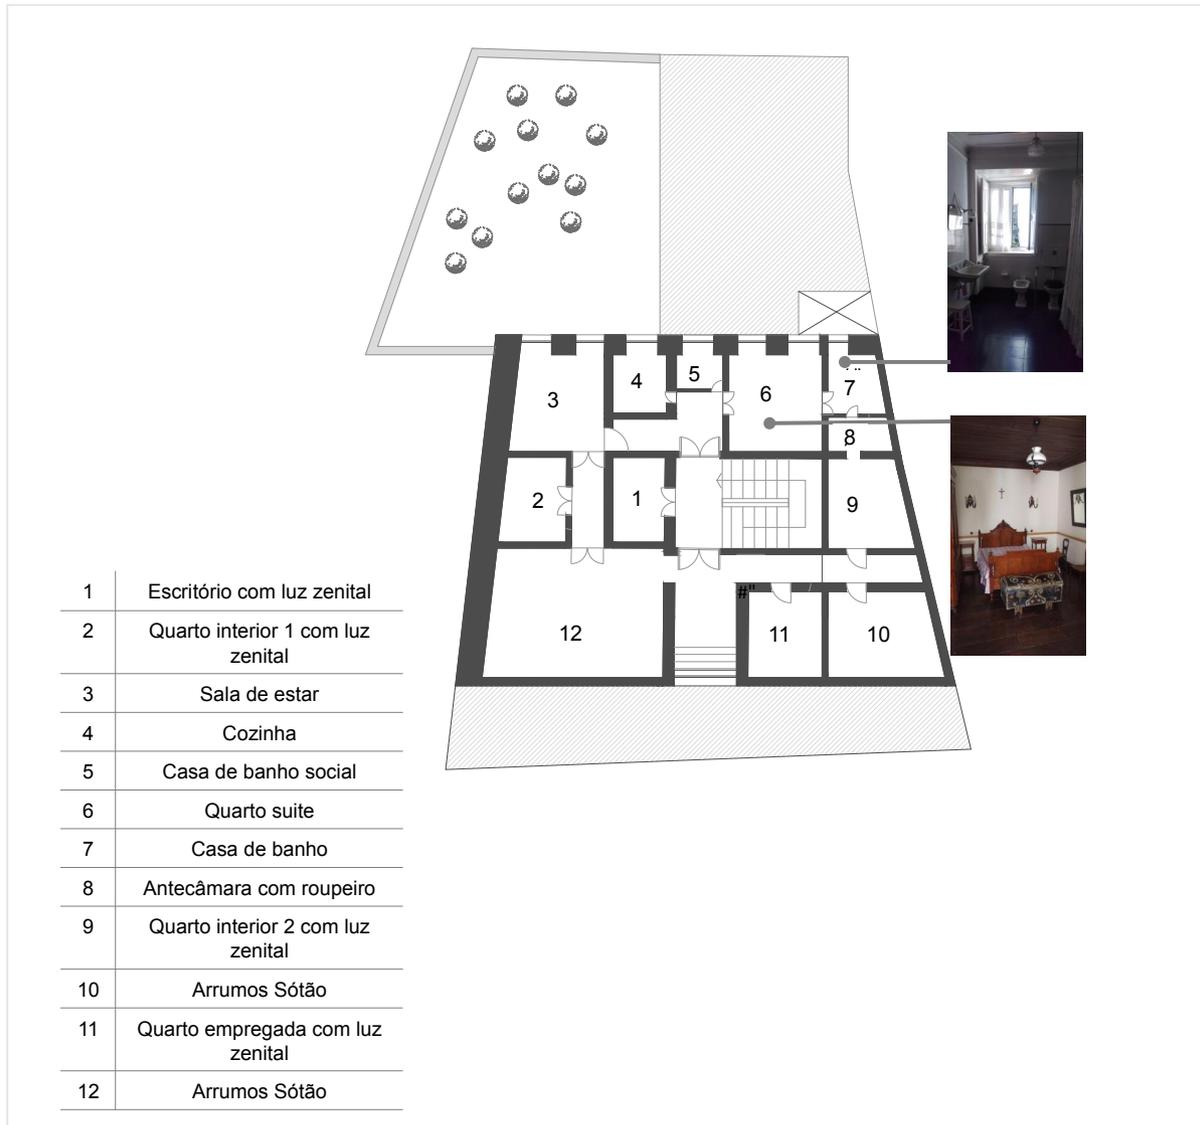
Planta piso 2 Sótão casa particular 2017.
